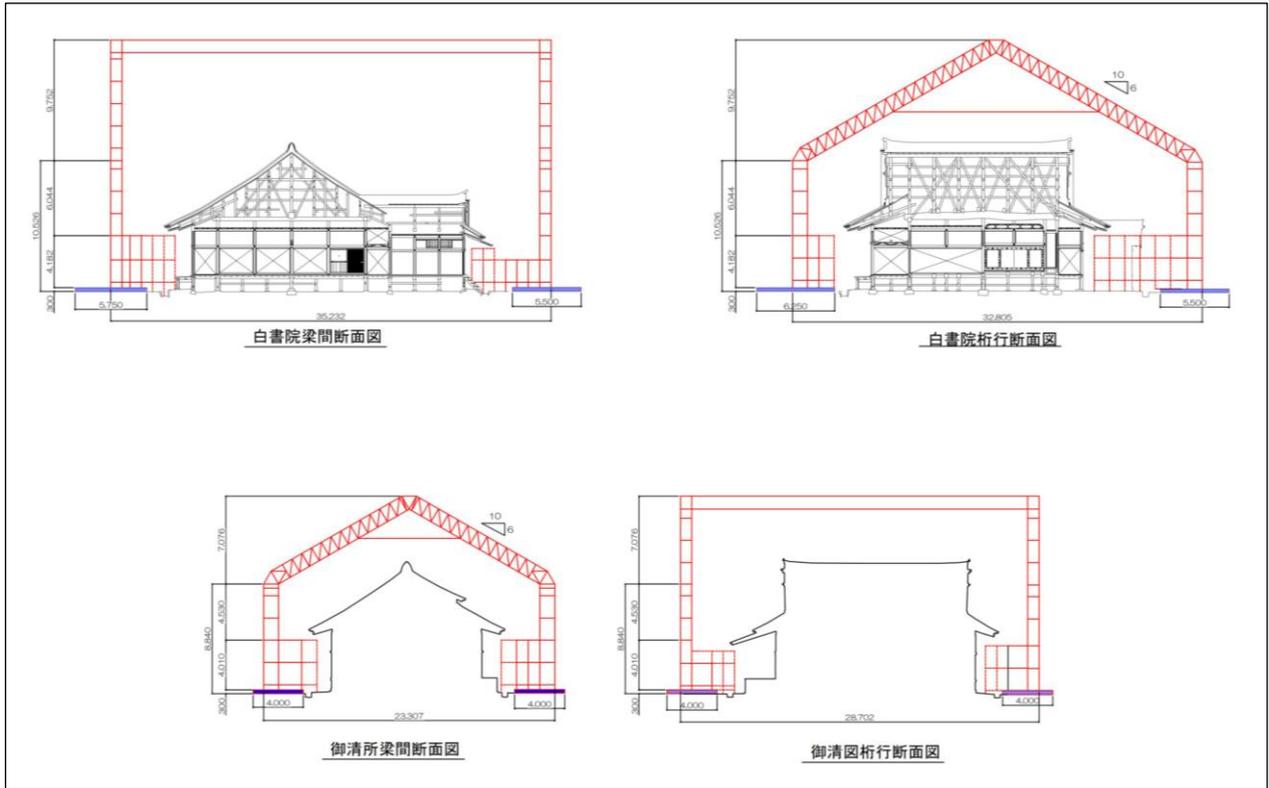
素屋根立面图·断面图（白書院·御清所）（A工区）
